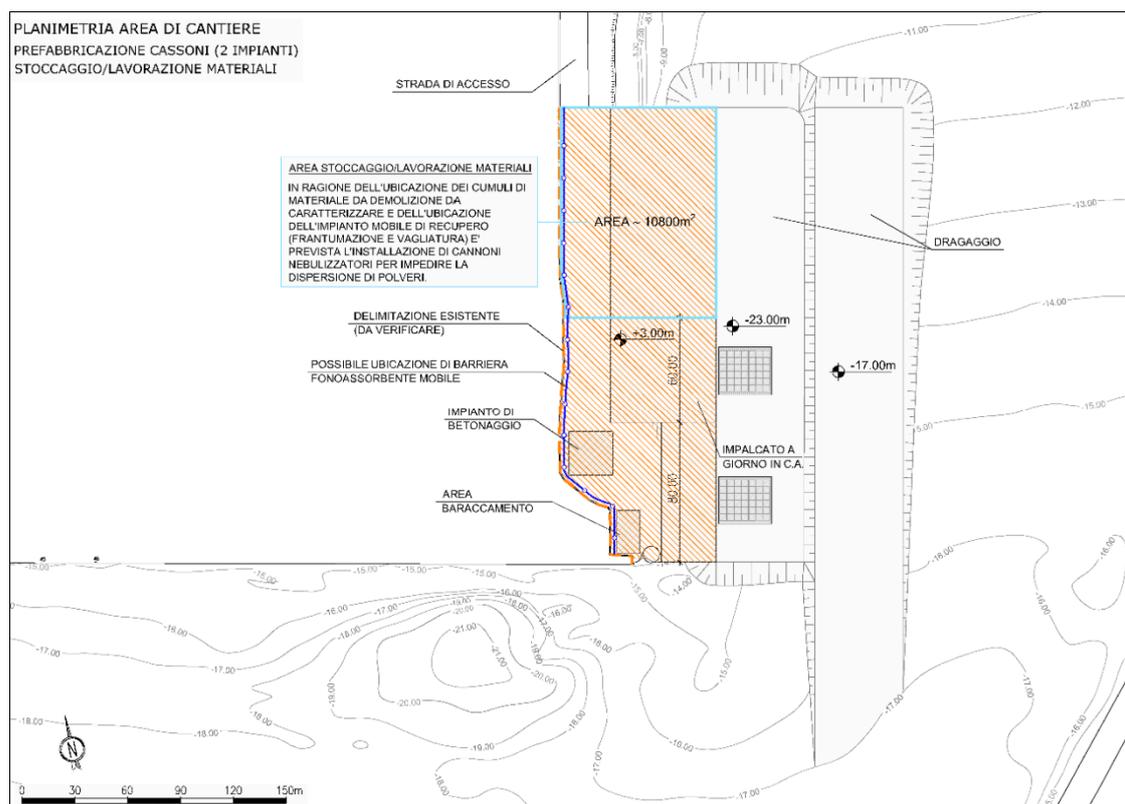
PLANIMETRIA AREA DI CANTIERE DI PRÀ-VOLTRI. FASE B)
